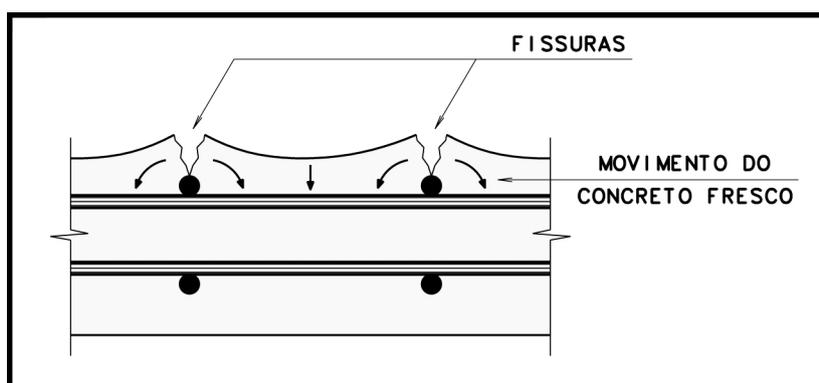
Exemplo de fissura de assentamento plástico ou movimentação de fôrmas.
